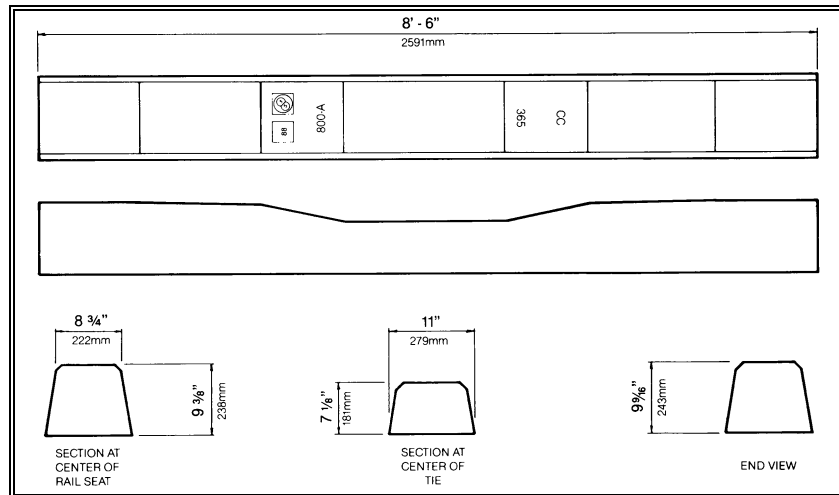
Dormente modelo CC365 para via de transporte pesado. (FONTE: CXT CONCRETE RAILROAD TIES - 1996).
